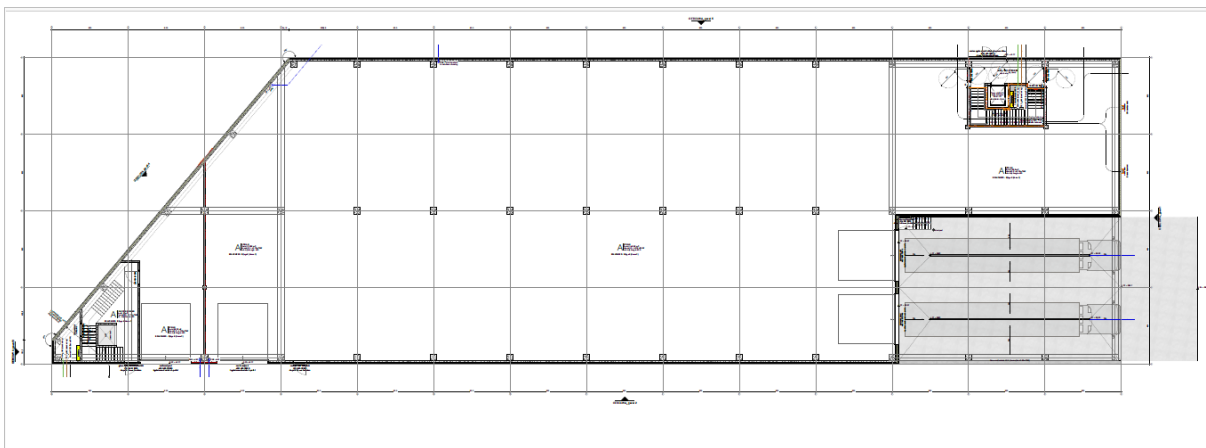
Inplantingsplan (opdrachtgever, 2025)
